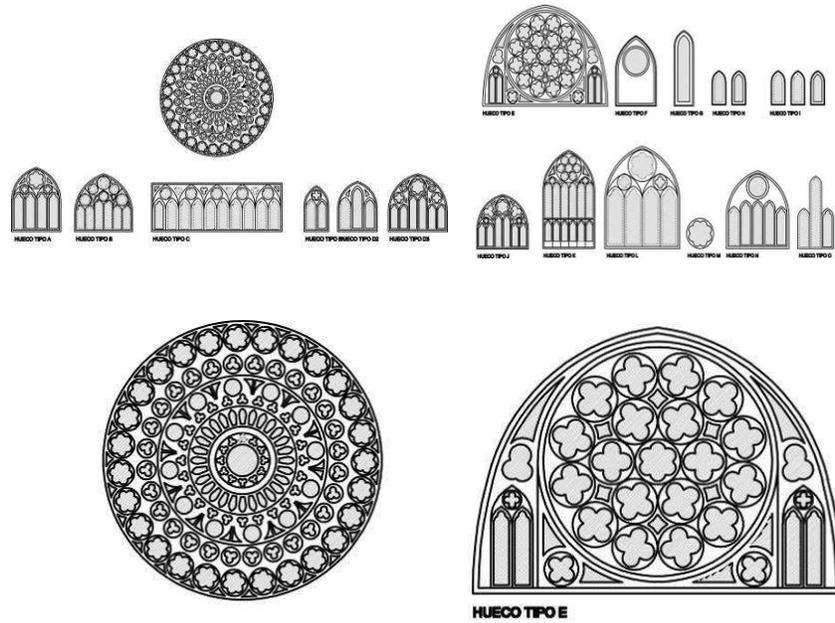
Levantamiento de los huecos de la catedral. Detalle de rosetones.
